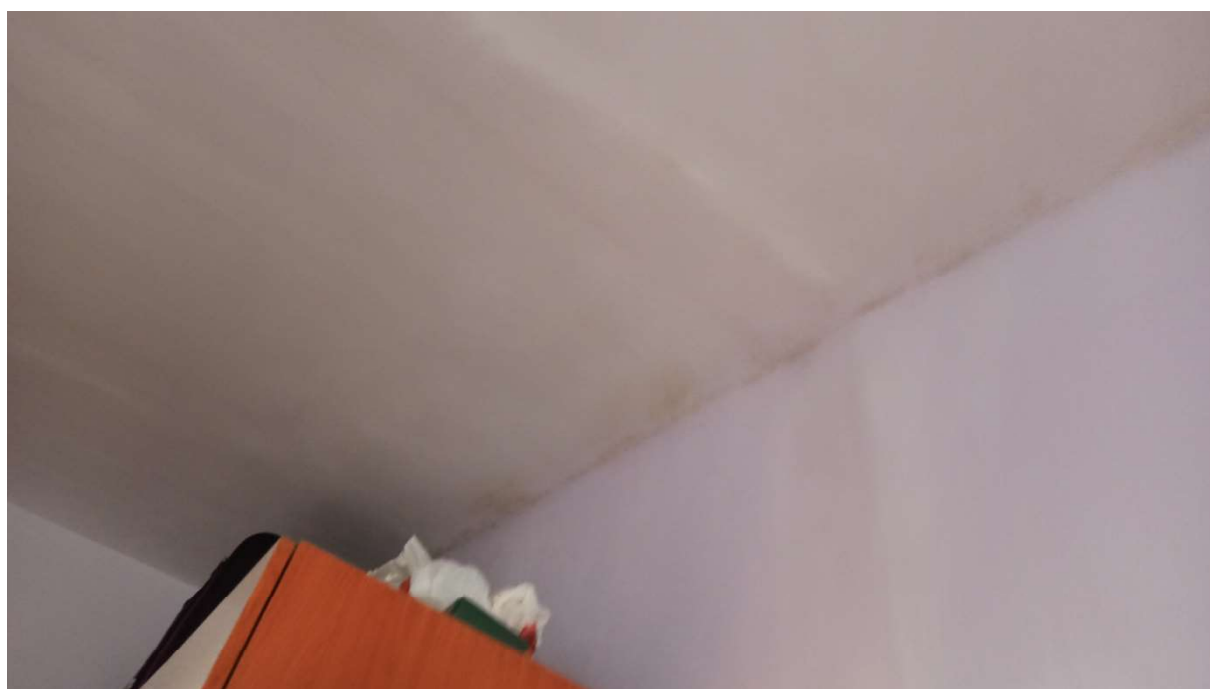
DETTAGLIO CONDENZA INTERNA AI LOCALI
